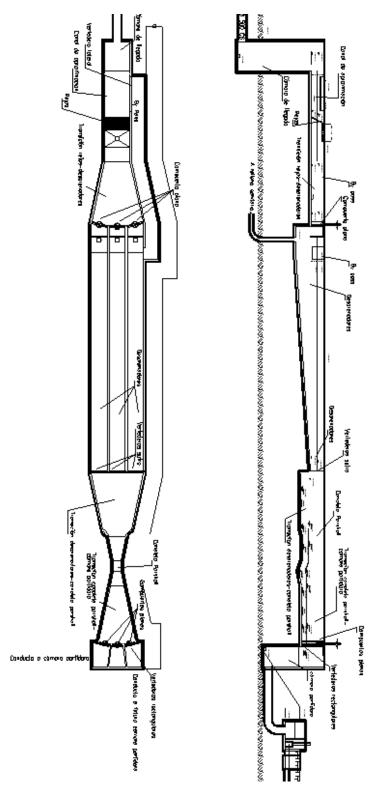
Planta y alzado del pretratamiento propuesto
